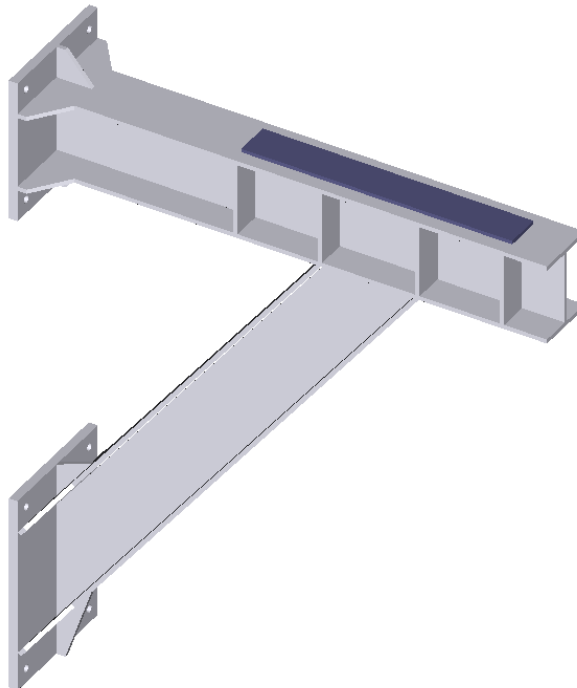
Detalle del apoyo entre pasarela y puente en las ménsulas extremas.
